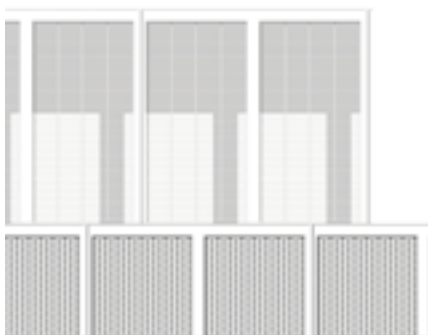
Dettaglio del prospetto est generale con in primo piano la fronte schermata dalle gelosie e sullo sfondo quella protetta dai frangisole lignei.
